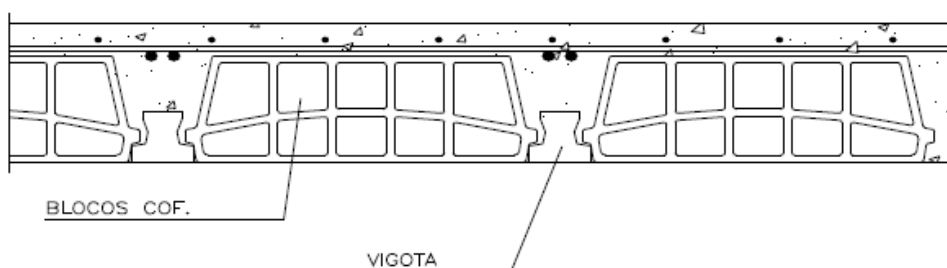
Laje aligeirada de vigota pré-esforçada
